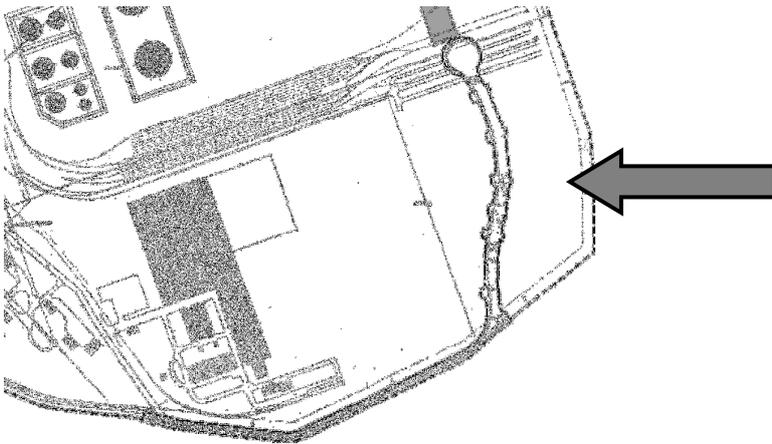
Bebauungsplan Nr. 37 A „Alte Rheinhäuser Weide, Änderungsplan I, 2. Änderung“, ohne Maßstab
